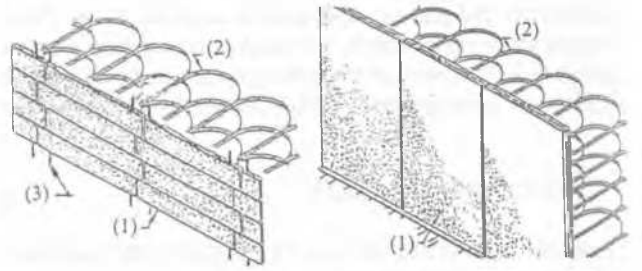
Structures TER-VOILE avec modules dalles ou panneaux
